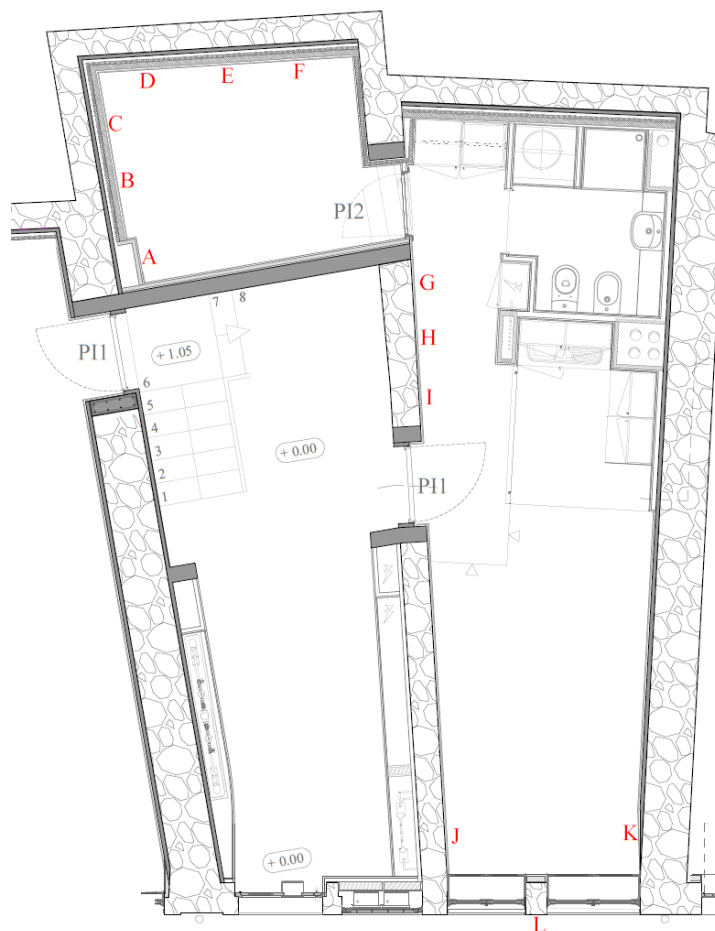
Planta da fração – zonas de medição (sem escala) (adaptado) [11].
